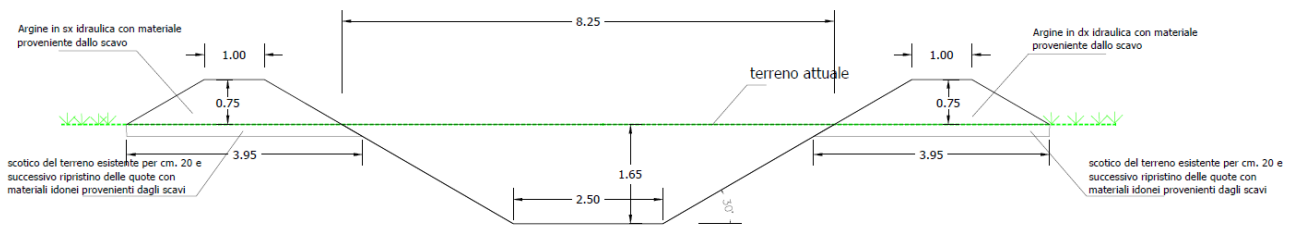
Sezione tipo - Canale a valle del 4 attraversamento
